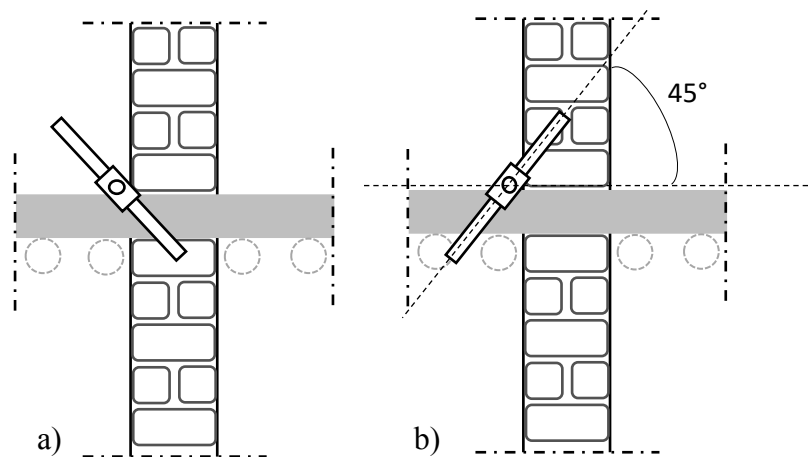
Disposition de la clé sous la forme d'un piquet (Source : auteur)
